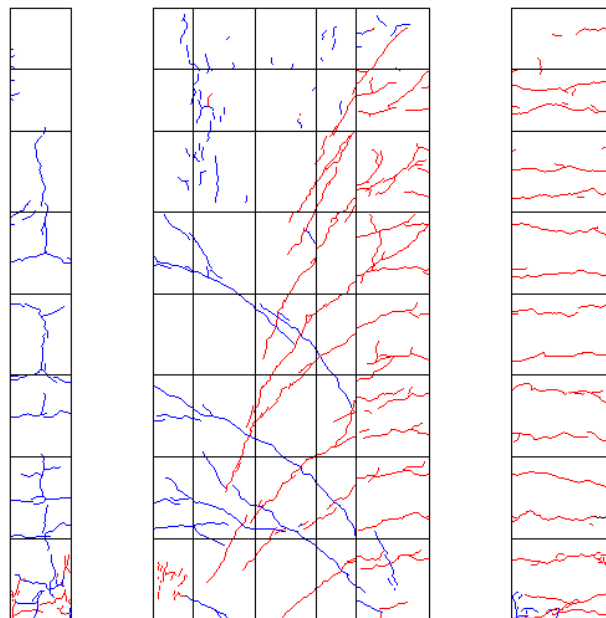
R=1/67②ひび割れ図
